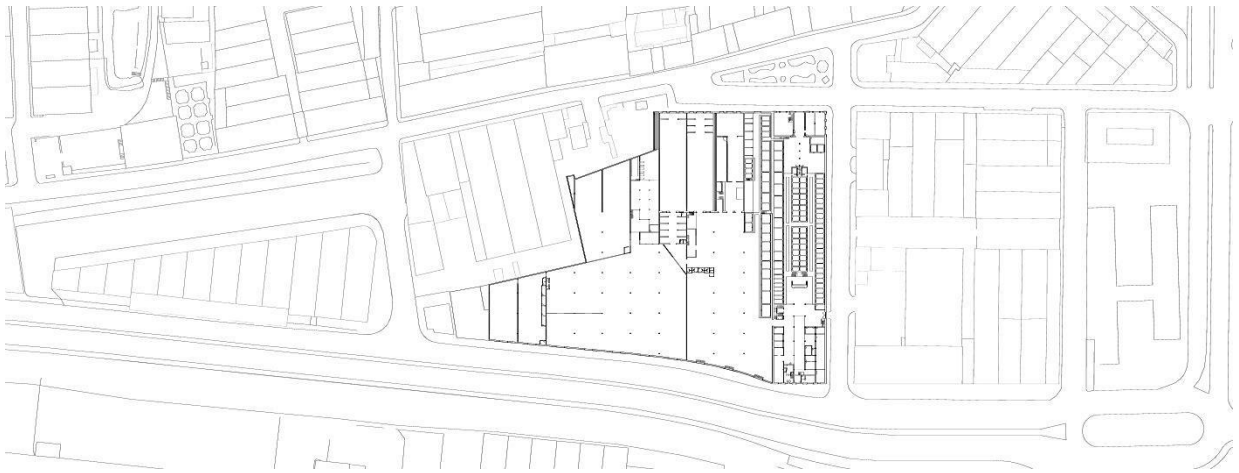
Planta de levantamento fotográfico piso térreo – Armazém 12.
